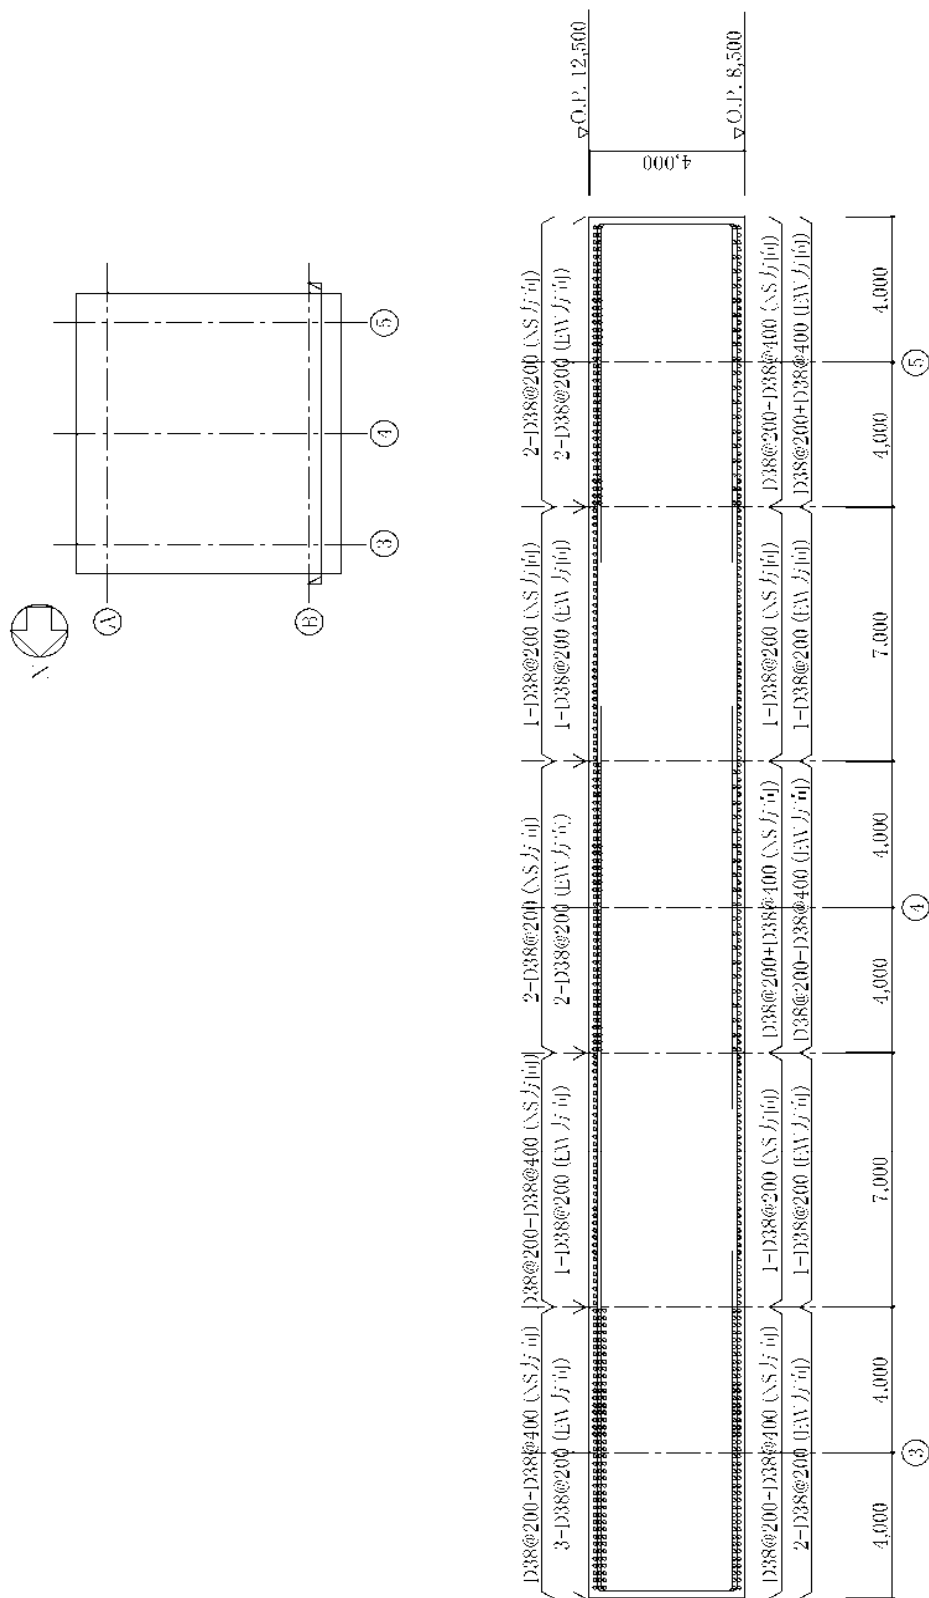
基礎スラブの配筋図 (B 通り) (単位: mm)
